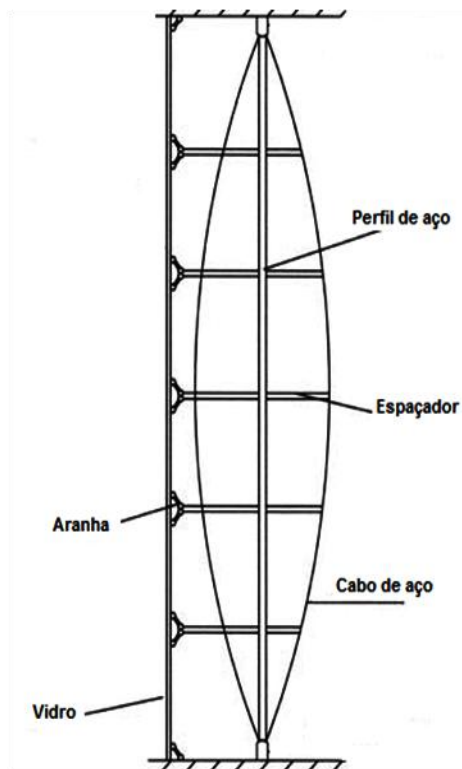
Estrutura de suporte composta por cabos parabólicos e perfil de aço [28].
